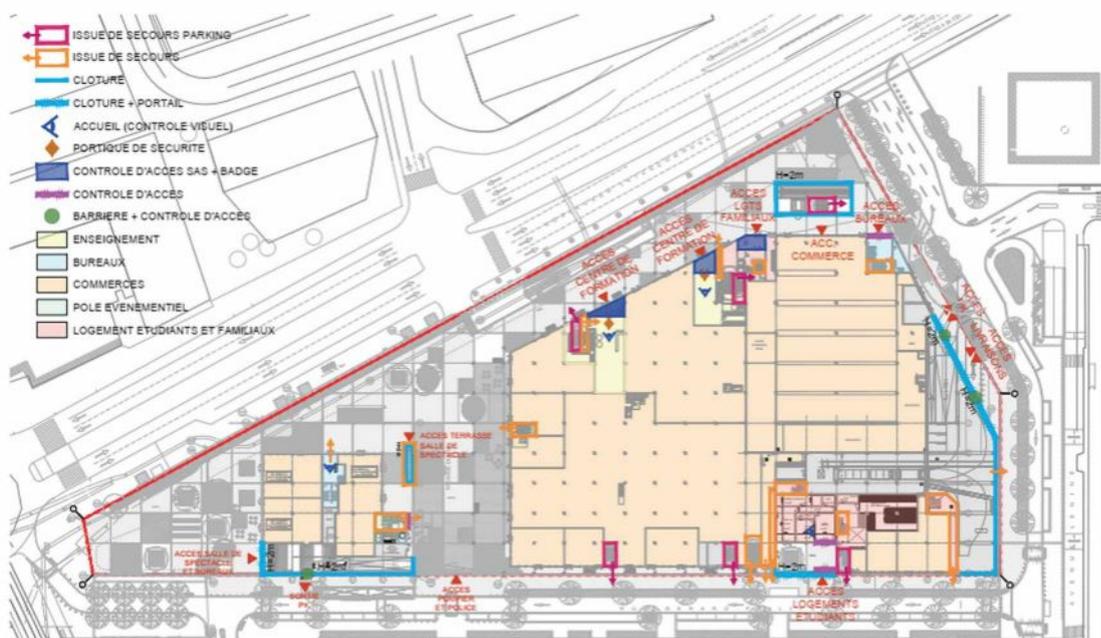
Plan du rez-de-chaussée – Source : Notice architecturale
